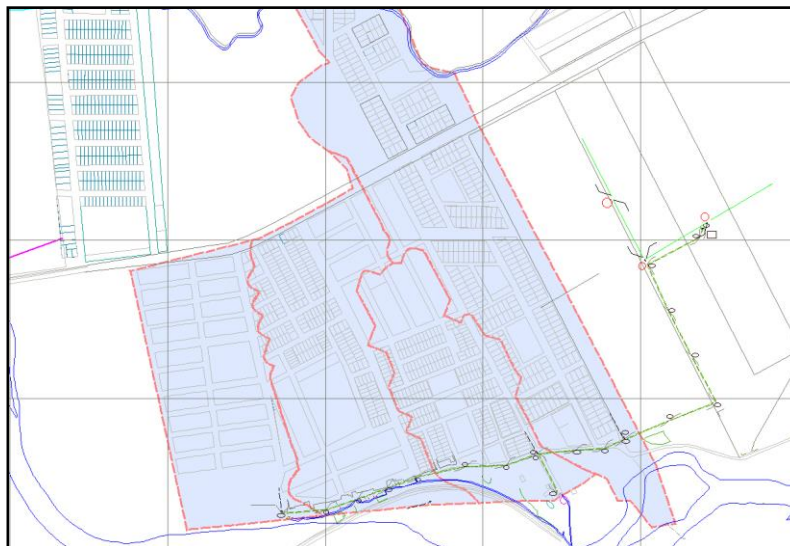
Trazado Sistema de alcantarillado sanitario
